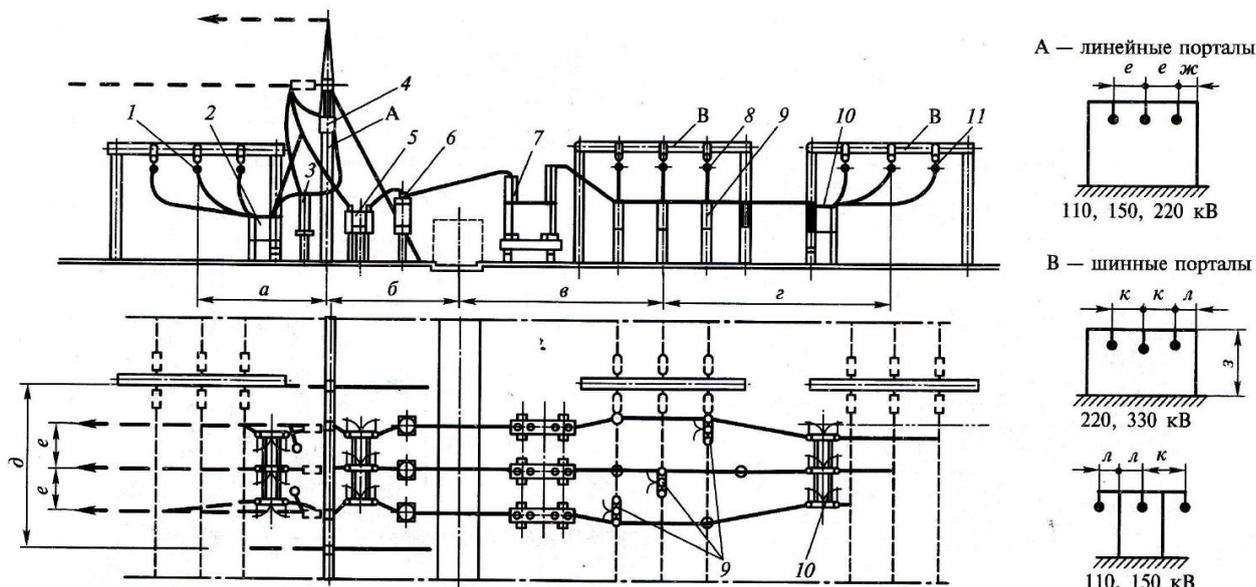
Типовая компоновка ОРУ 110-220 кВ для схемы с двумя рабочими и обходной системами шин: 1 – обходная СШ; 2 – разъединитель ОСШ; 3 – конденсатор связи; 4 – заградитель; 5 – линейный разъединитель; 6 – трансформатор тока; 7 – воздушный выключатель; 8 – вторая СШ; 9 – шинные разъединители килевого расположения; 10 – шинные разъединители; 11 – первая СШ
